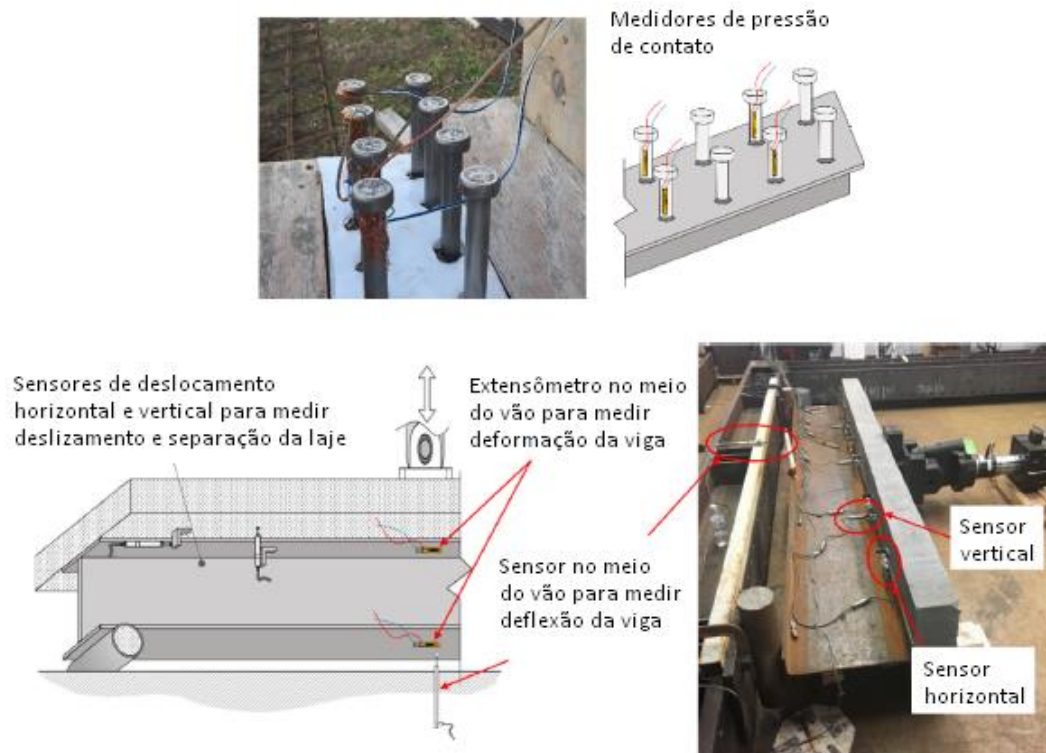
Confecção da viga mista ensaiada por Hillhouse e Prinz (2020)
